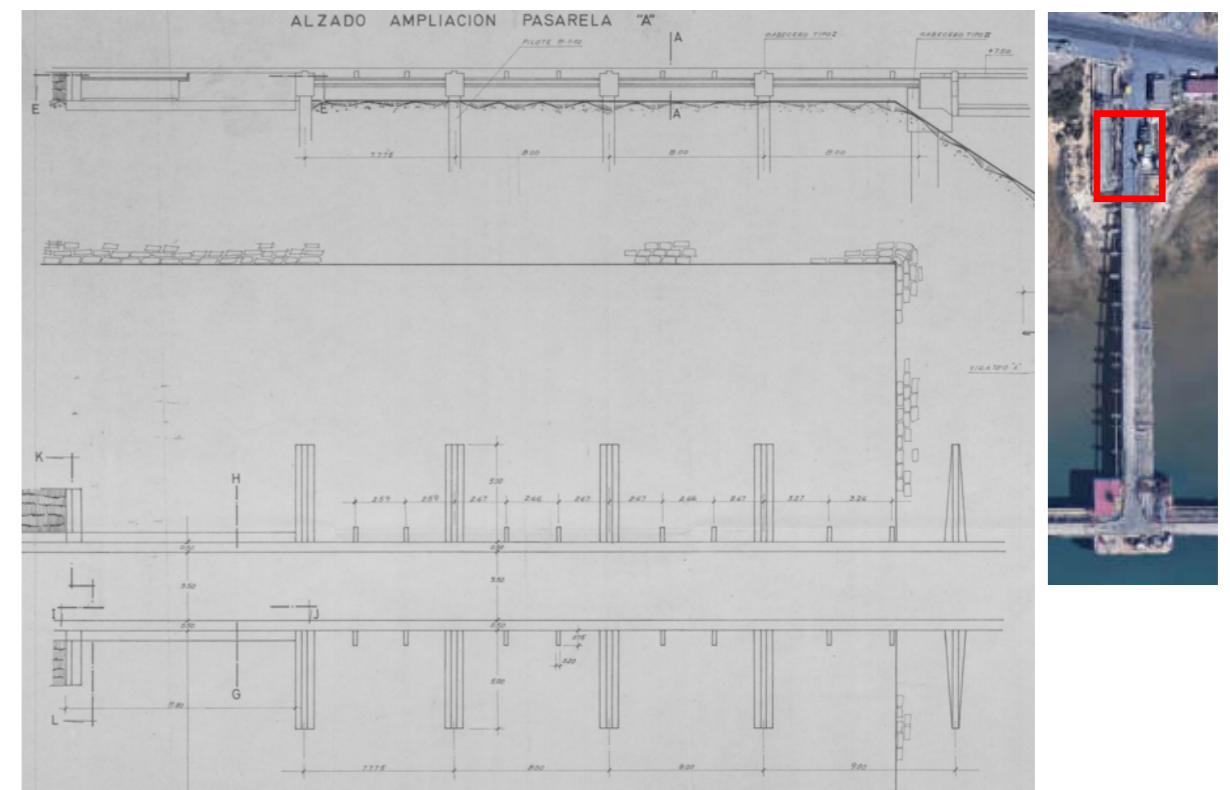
Tramo 1 de la pasarela de acceso - tramo tierra (Fuente: Planos del proyecto constructivo)
